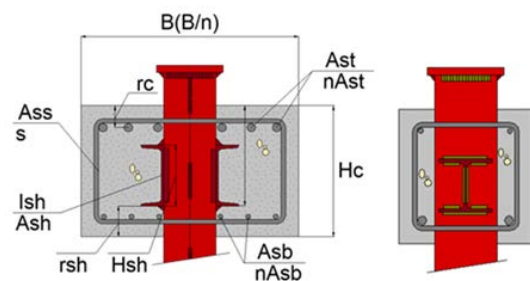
Secciones transversales de viga. Detalle de crucetas con las dimensiones características necesarias para obtener las propiedades mecánicas y resistentes de la sección mixta en las proximidades del pilar.
